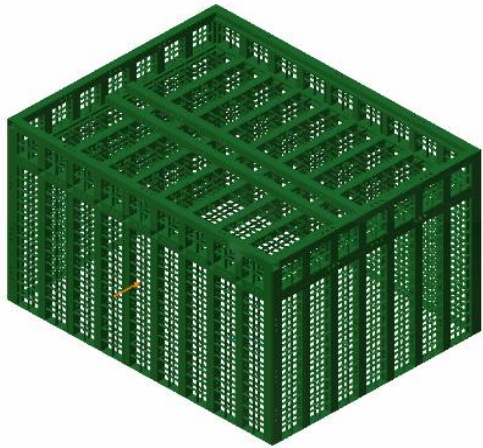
Estrutura de teste, com 4,5 metros de largura por 5,5 metros de comprimento, com carregamento de 10 kN na parede.
